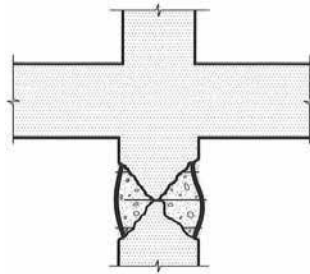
Rotura del pilar con desprendimiento del recubrimiento y pandeo de armaduras (Fuente: Calavera, 2005)
